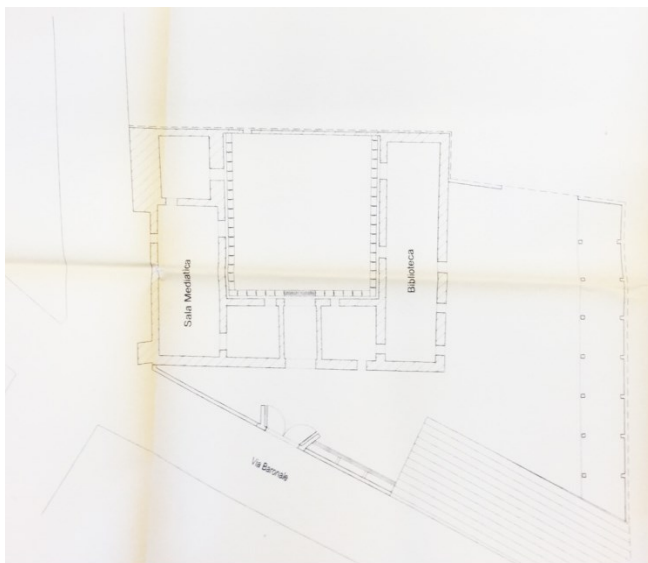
Planimetria di progetto per il recupero, la valorizzazione e la fruizione del castello di Villasor del 2005 (ASBEAP_CA-OR)
